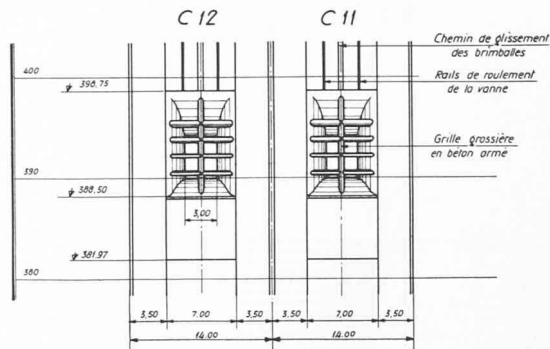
Vidanges de fond. Grilles amont en béton armé.
